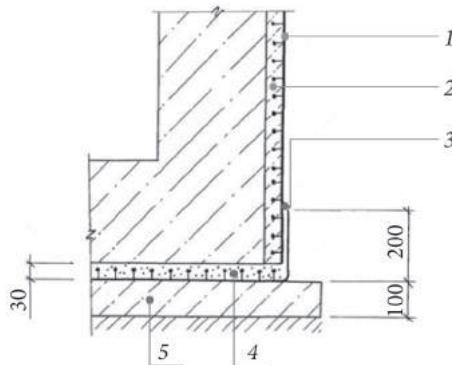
Схема устройства гидроизоляции из профилированных полиэтиленовых листов: 1 — профилированный полиэтиленовый лист; 2 — сборные панели несъемной опалубки; 3 — сварные швы; 4 — цементно-песчаный раствор М100; 5 — подготовка из бетона класса В12,5
